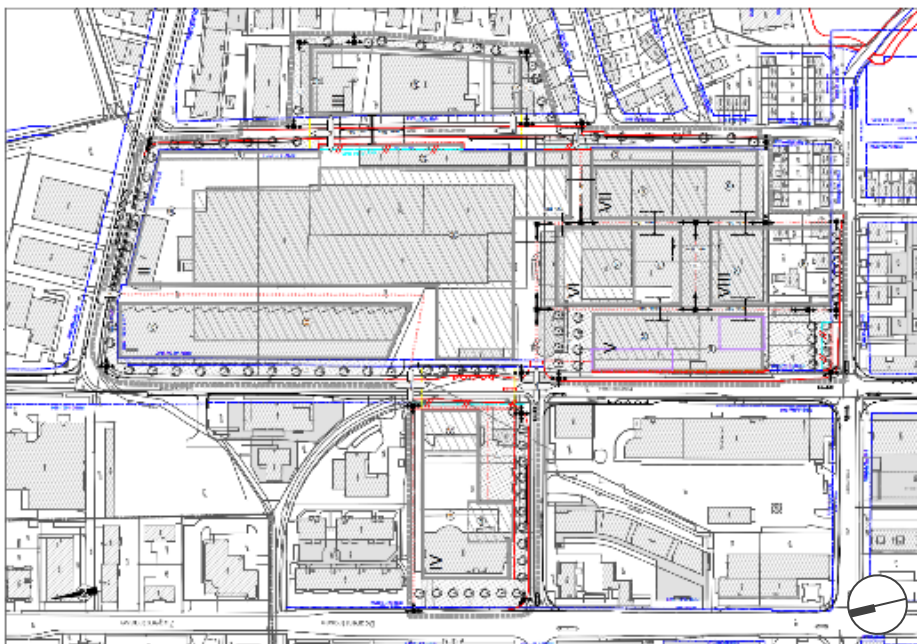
Bebauungsplan mit den 8 Baubereichen
